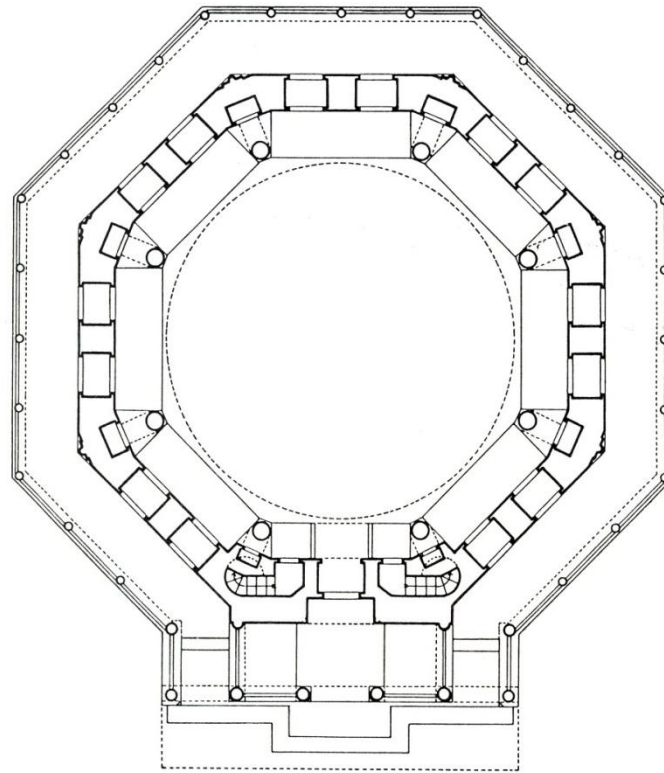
Grundriss Sultan Süleyman I. Mausoleum, 1566, Istanbul, Türkei.
